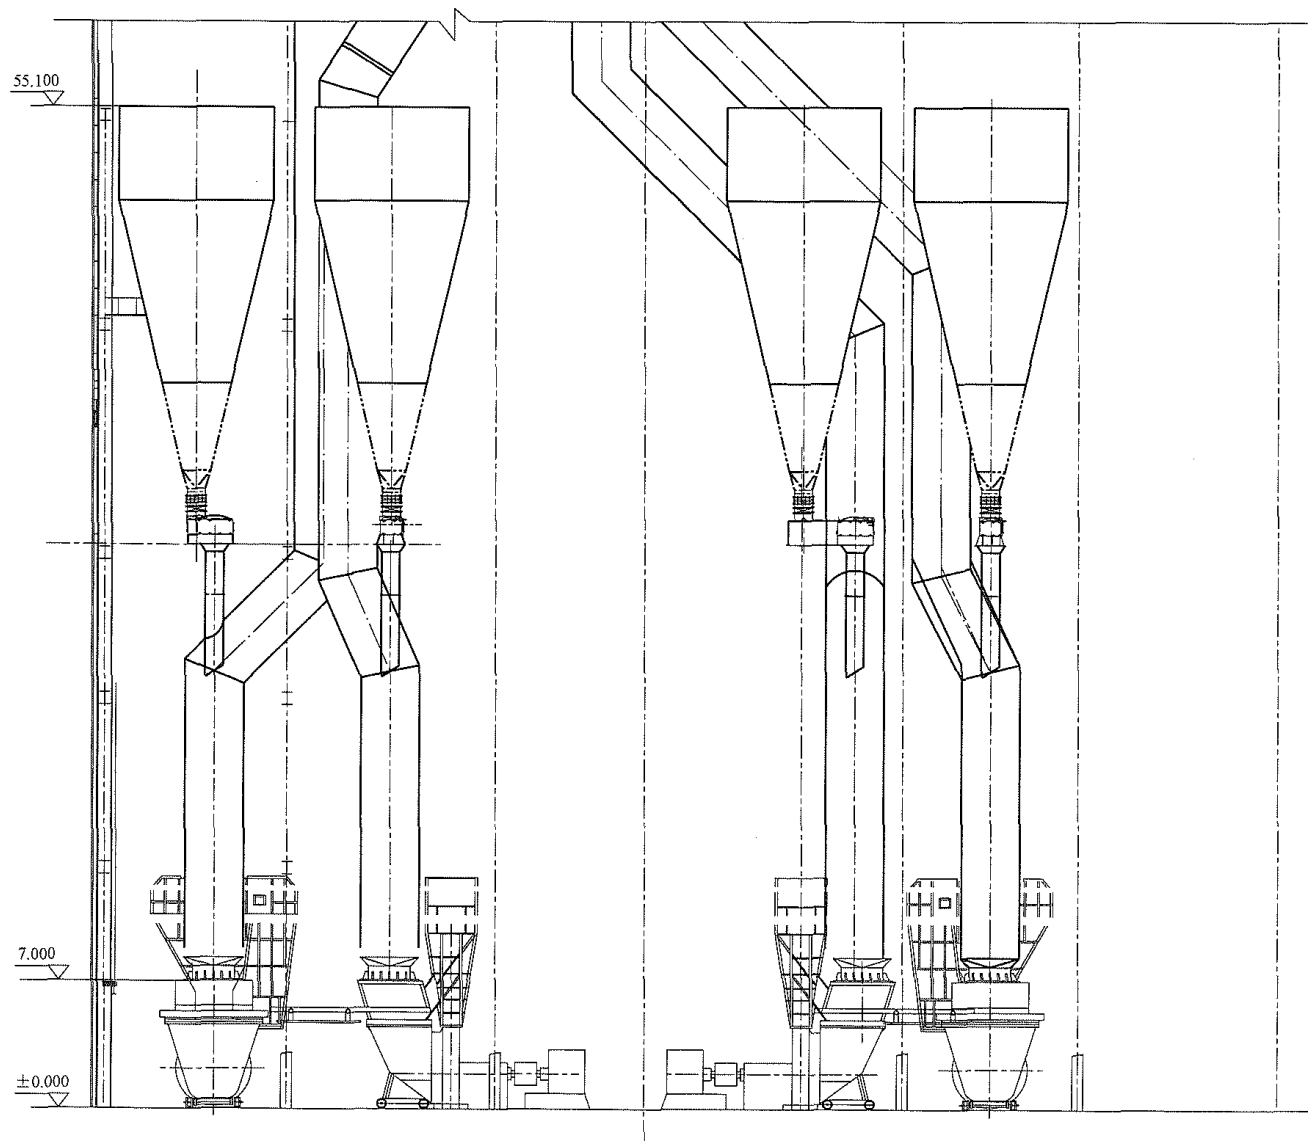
600MW 级机组风扇磨煤机侧煤仓横断面布置图
